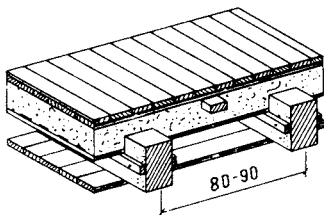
Перекрытие средней степени воспламеняемости с опущенным настилом
